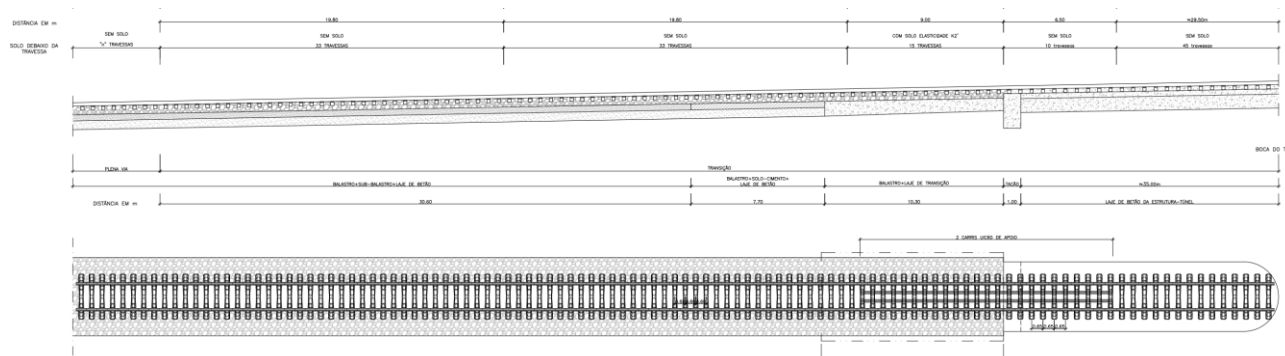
Pormenor de transição entre via balastrada e via betonada.
